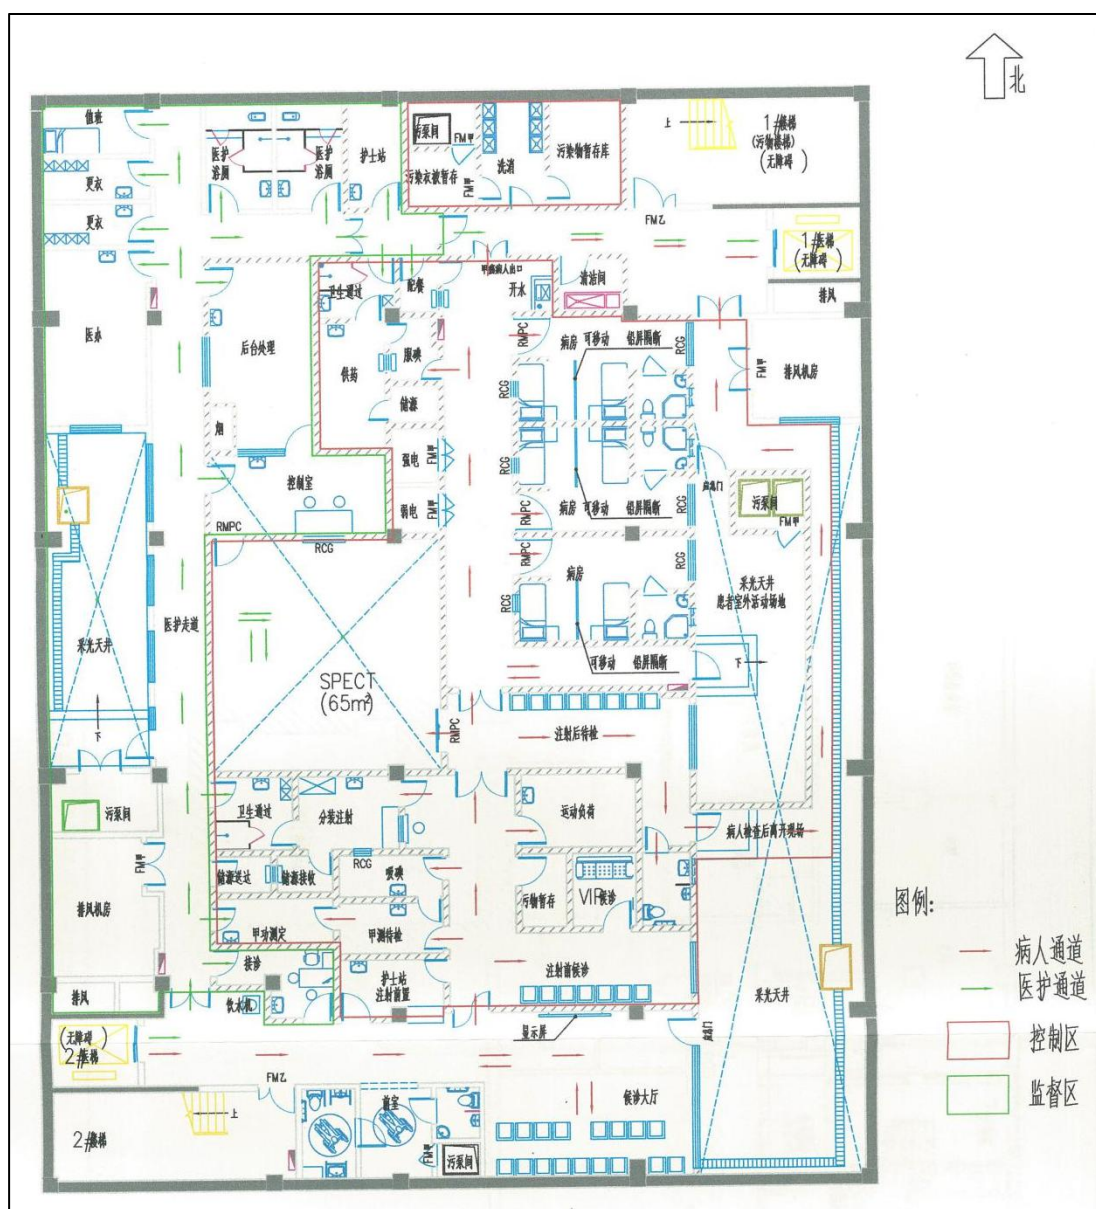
本项目核医学楼平面布置、分区及人员流动路线示意图
